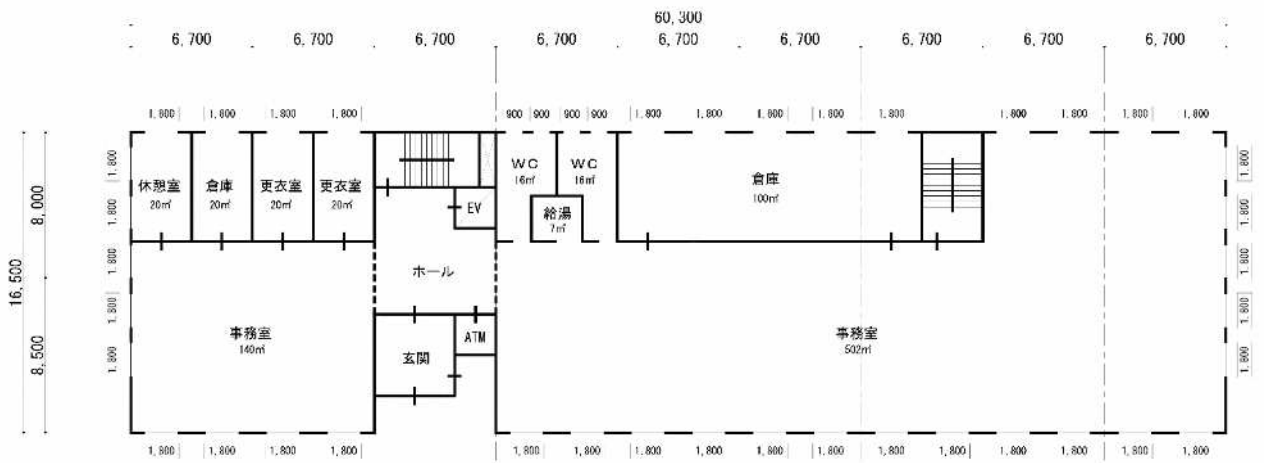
庁舎(1,000 m²)検討モデル 平面図
